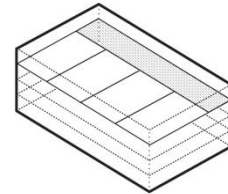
Lageplan Erdgeschoss Wohngruppe »Junge Alleinerziehende« mit Gemeinschaftsflächen, Projekt MM11* mitten im elften. Stand Einreichung 2012.
